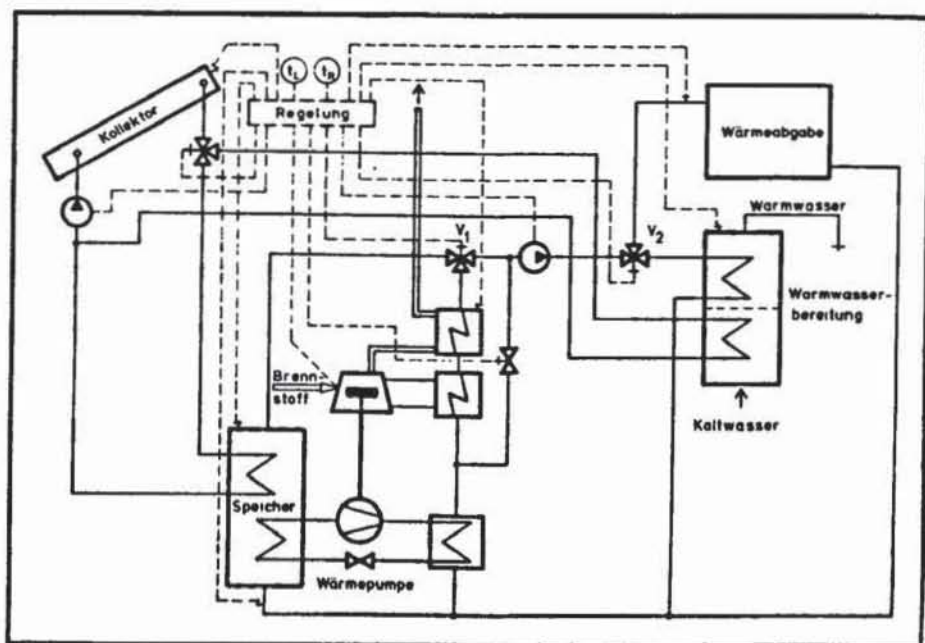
Prinzipschaltbild der Solaranlage mit dieselmotorbetriebener Wärmepumpe
